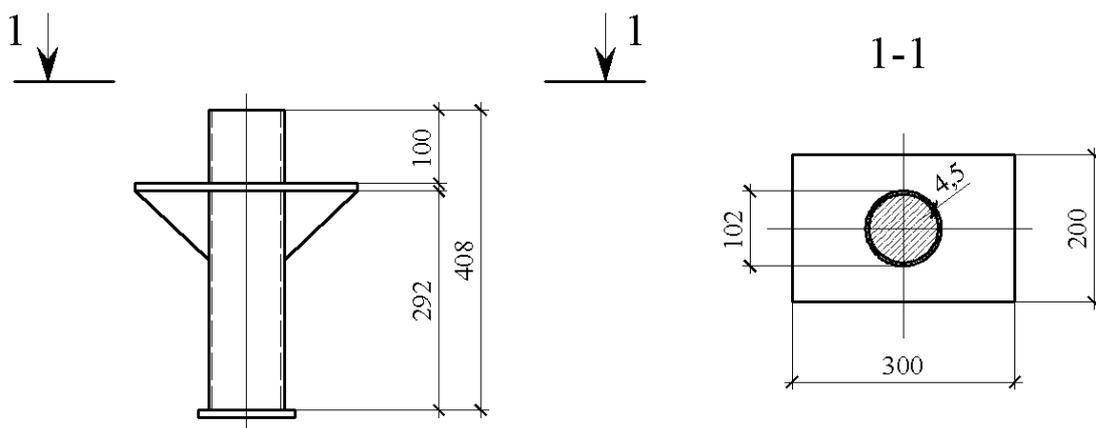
Схема дослідних трубобетонних зразків з консолями
